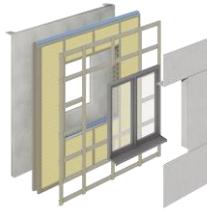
Фасадный стеновой модуль TOPWALL от «Modulbau»
